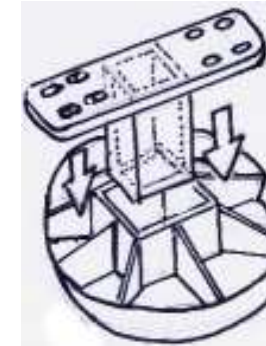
Pilotis : Montage Patin support, platine et poutrelle horizontale extérieure du plancher (B).
